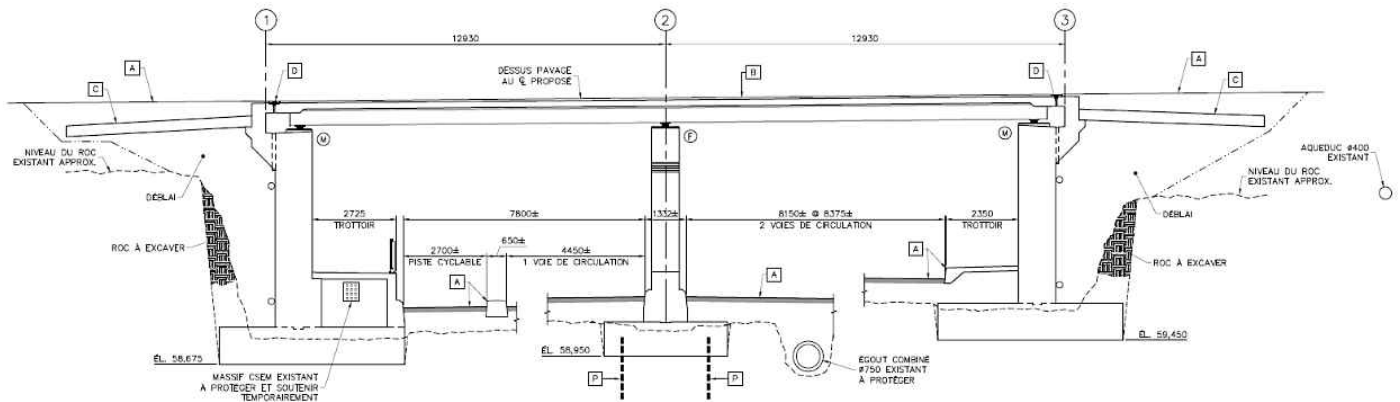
Extrait du plan d'ensemble du scénario 1 – Option poutres en acier – Coupe au CL proposé
